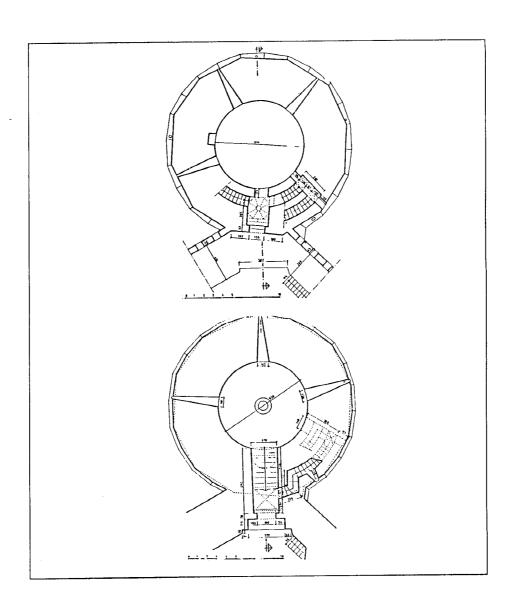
مسقط أفقي لبرج سارياجا باشا بروملي حصار (عن : إيفردى) .
